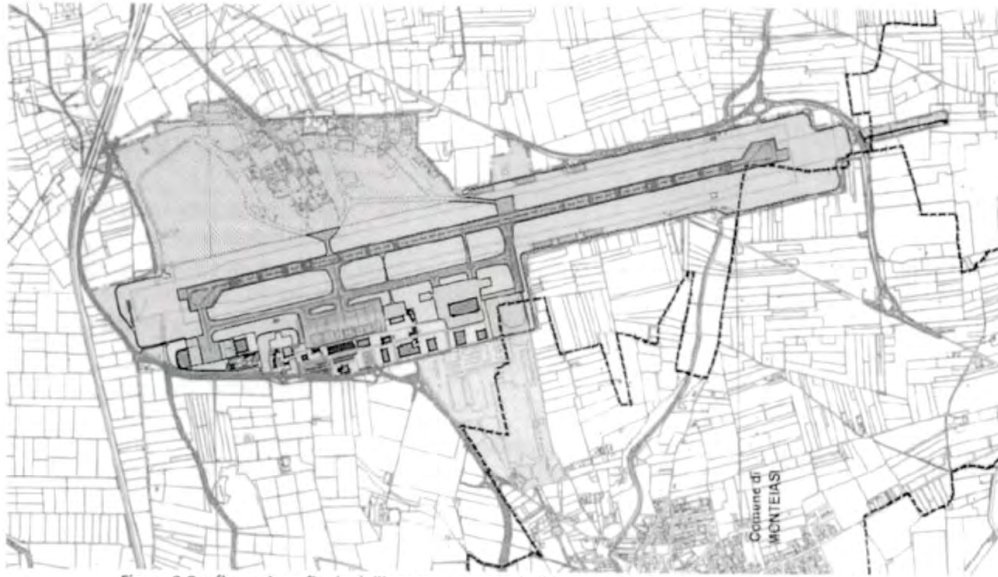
Configurazione finale dell'aeroporto secondo il layout infrastrutturale individuato dal PSA
